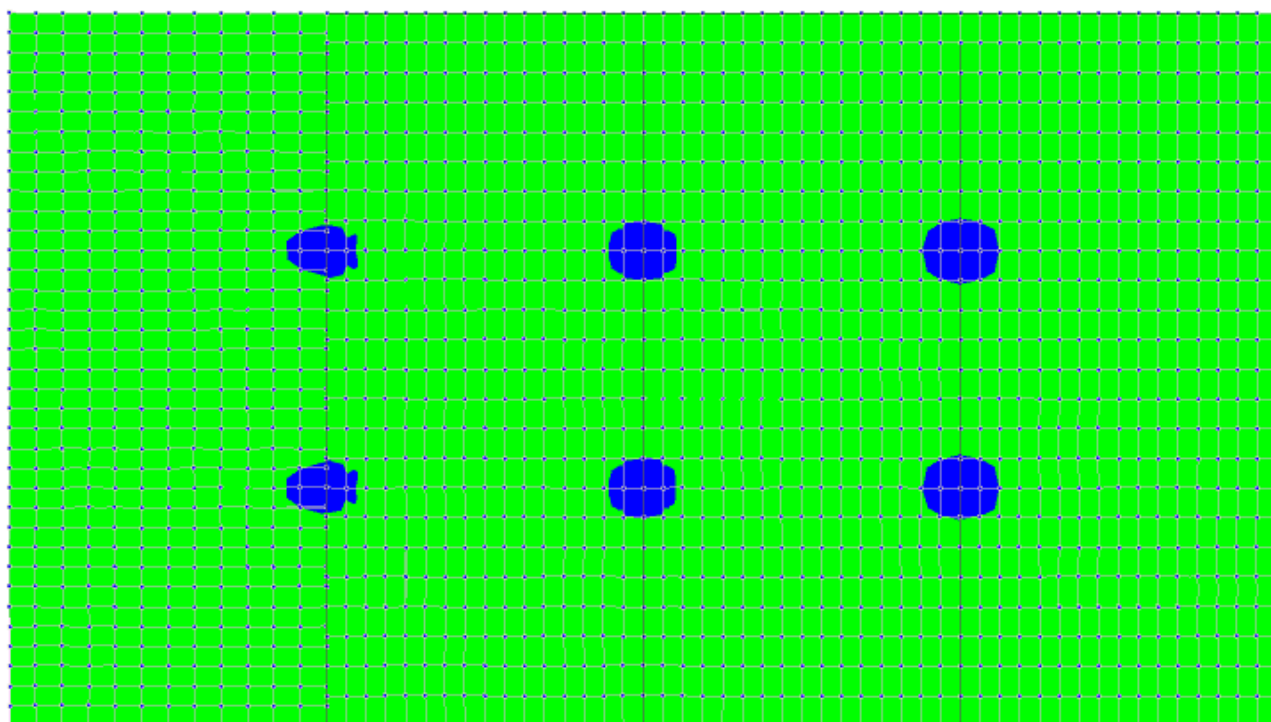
Изополя армирования перекрытия (верхняя грань по оси Y)
